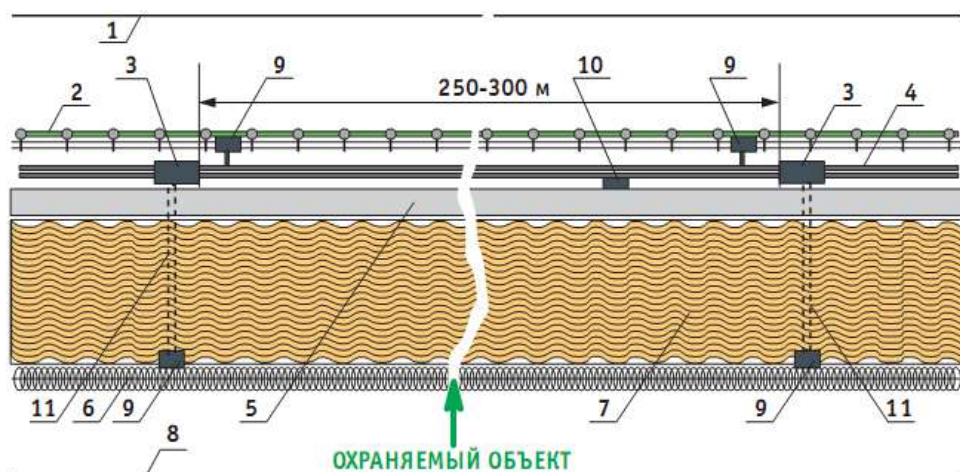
Второй вариант размещения элементов СОП на рубеже охраны где:
